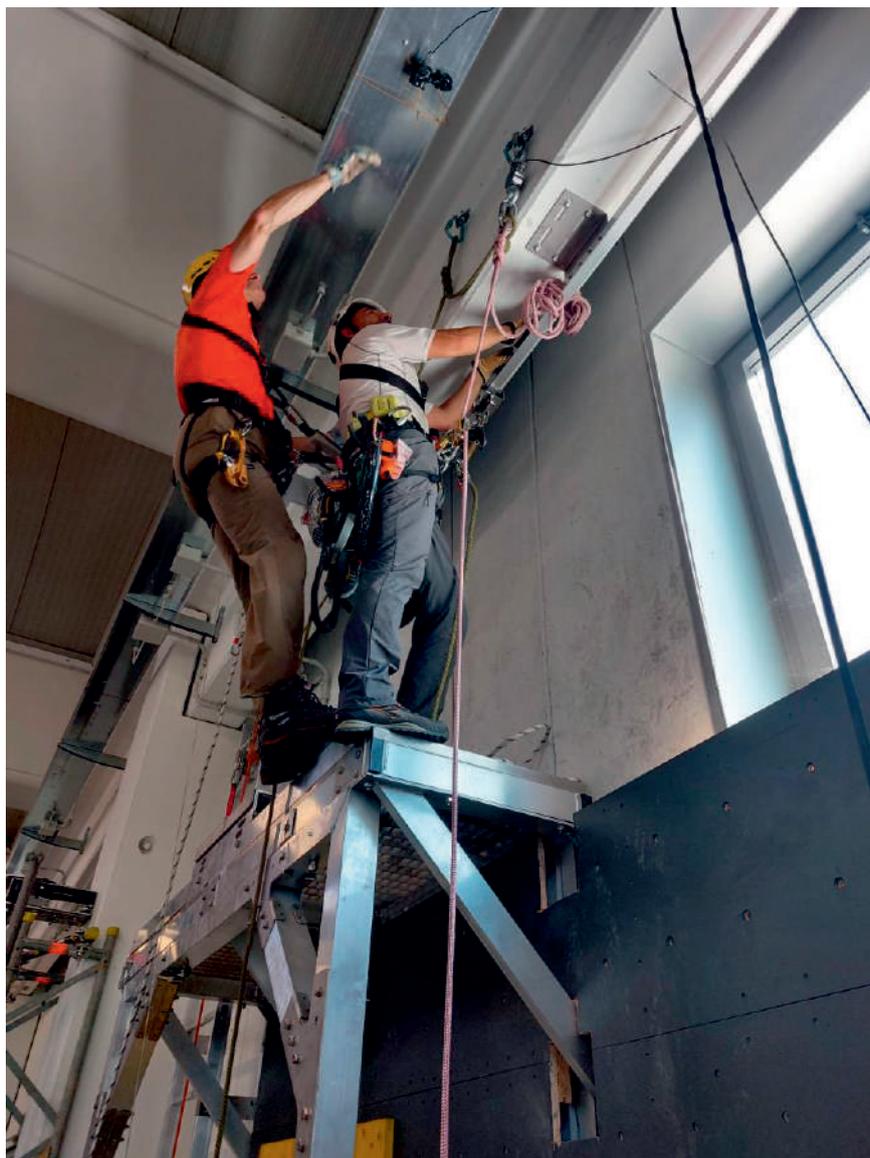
Sistema di accesso su corda - Struttura di prova
